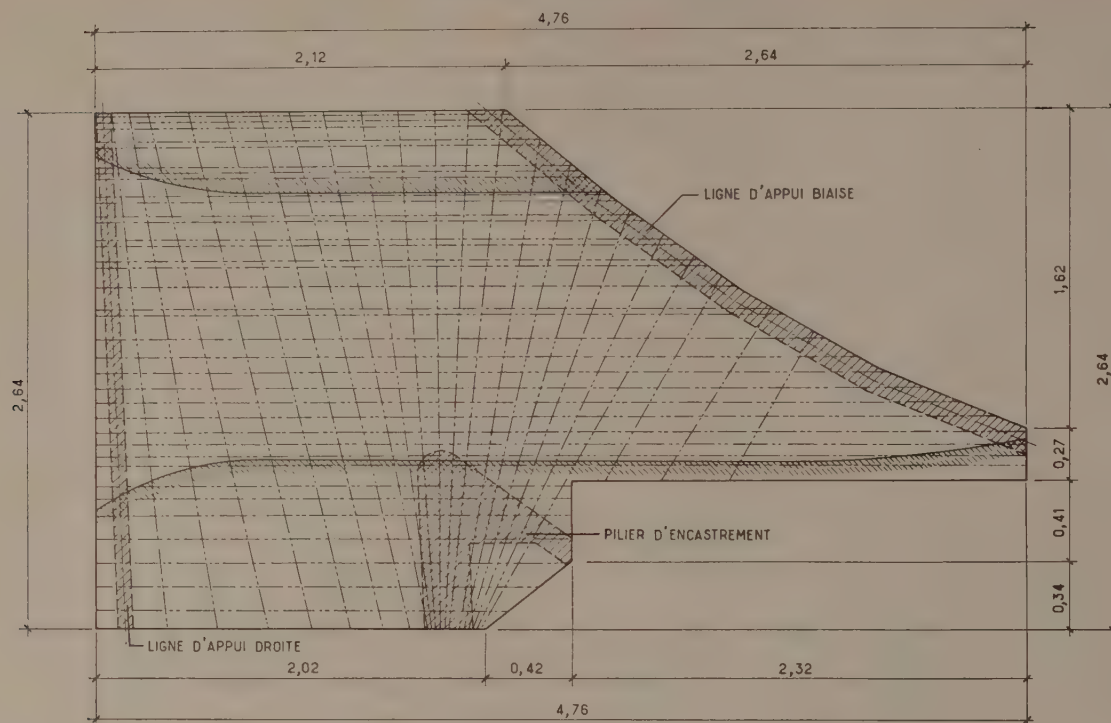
Relevé schématique de la fissuration de la maquette de la dalle C.
